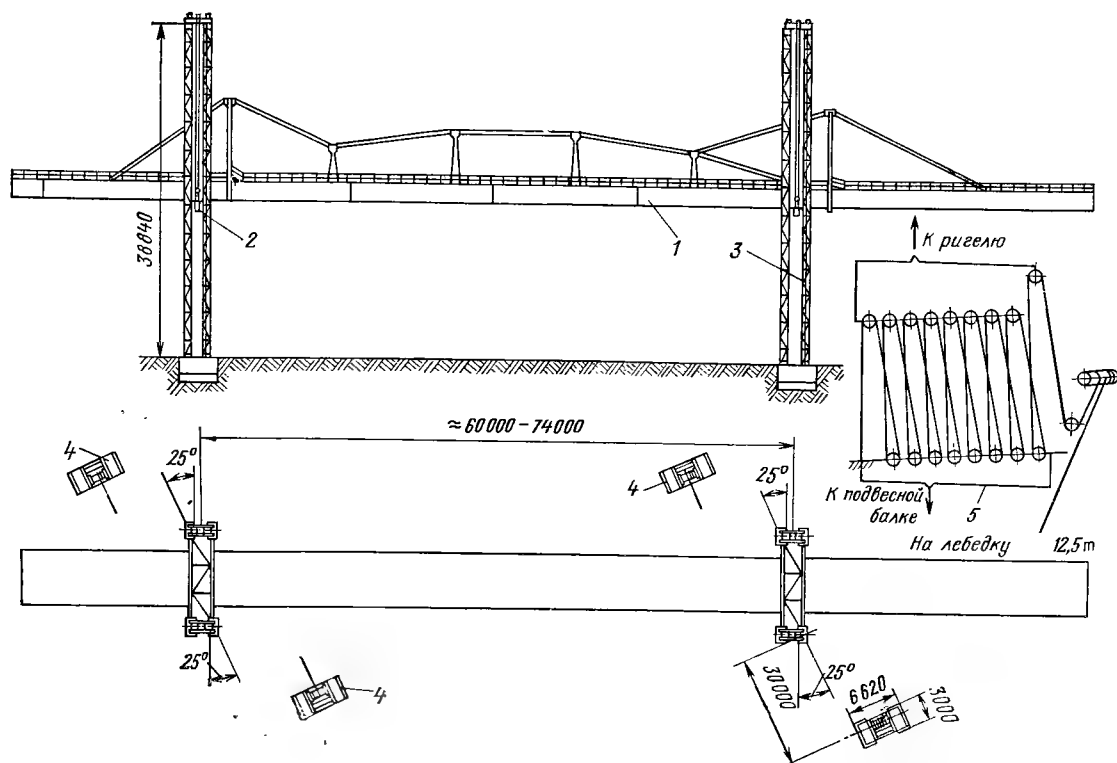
Схема монтажа крана-перегрузчика при помощи монтажного канатного подъемника без расчалок.
